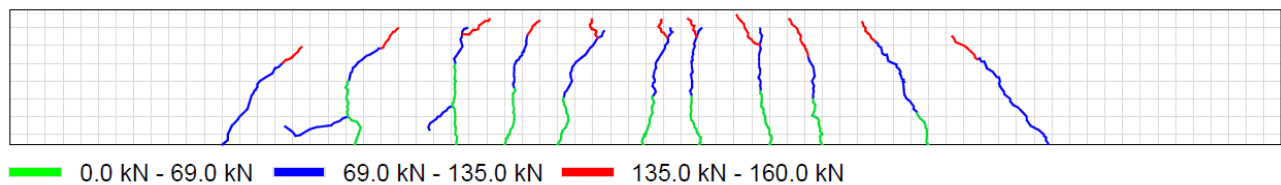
Fisuración y modo de falla de las vigas control V1B y V1C
